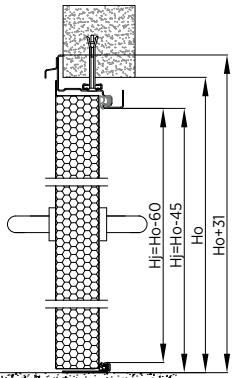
Pose au mur - bloc-porte à un vantail, bâti angulaire à rupture de pont thermique - coupe verticale
